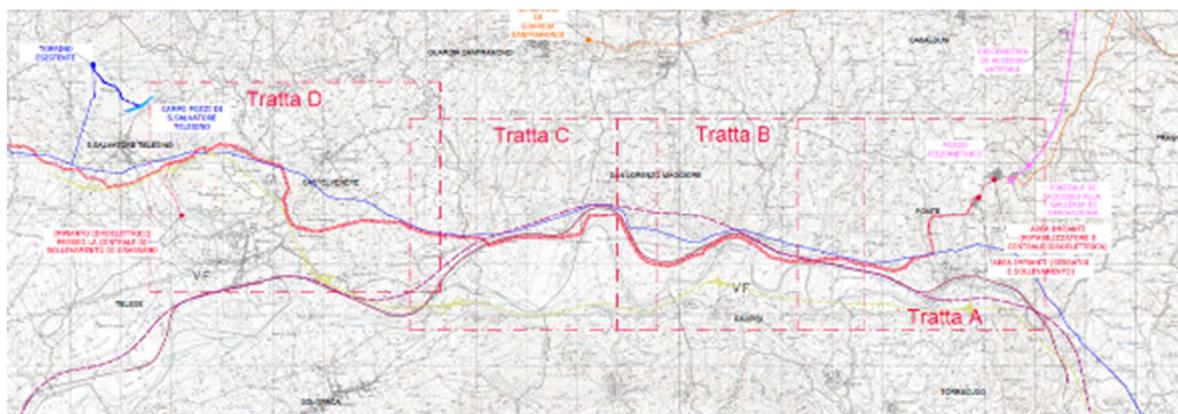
Planimetria Condotta irrigua (in rosso)
